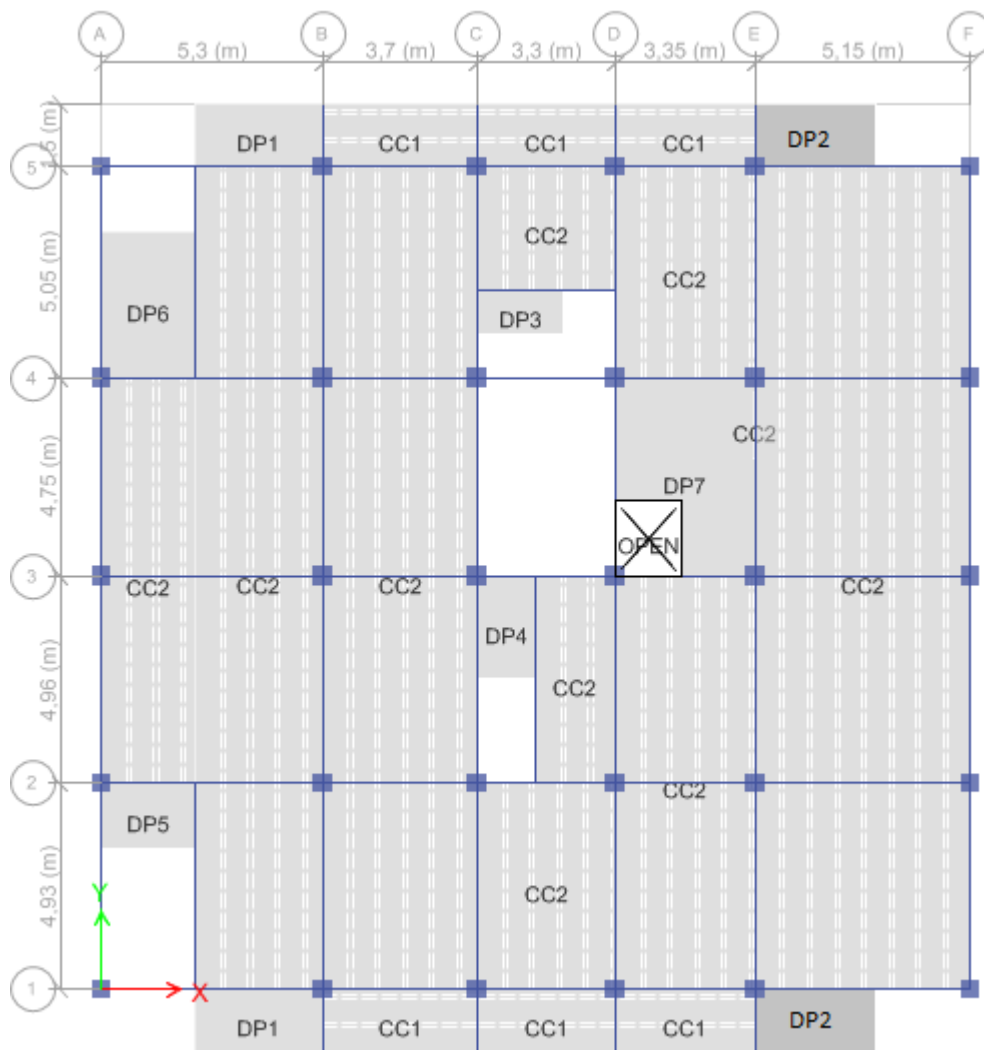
Disposition des poutrelles 2^{ème} étage jusqu'au 9^{ème}
